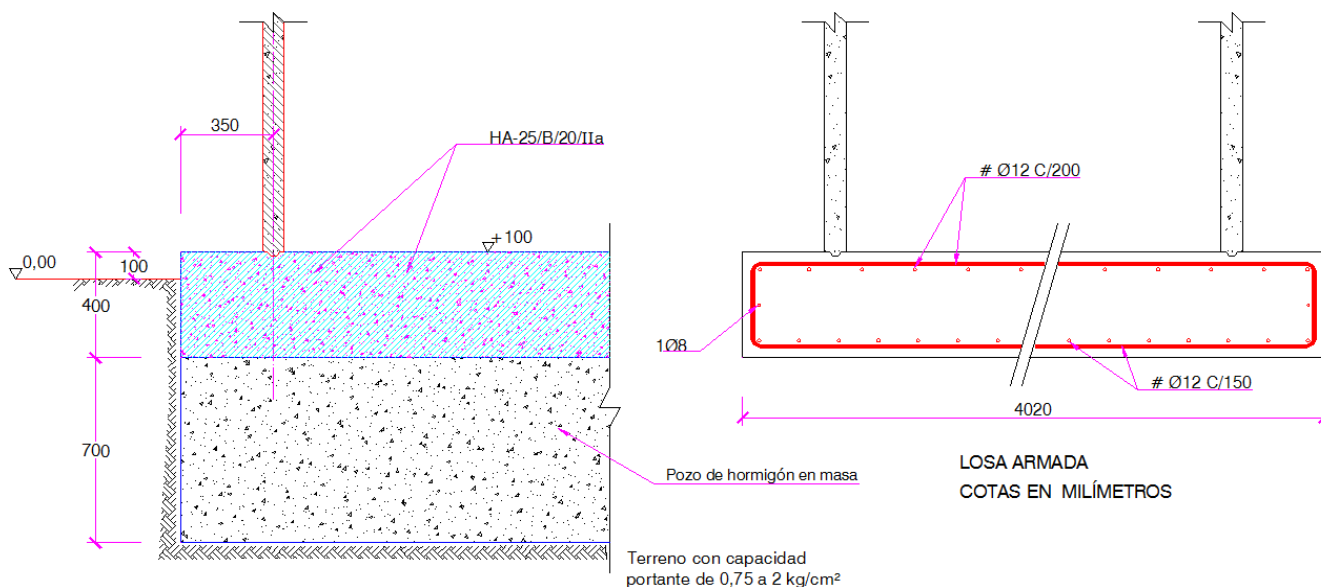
Detalle de la cimentación del primillar para terrenos de baja capacidad portante
